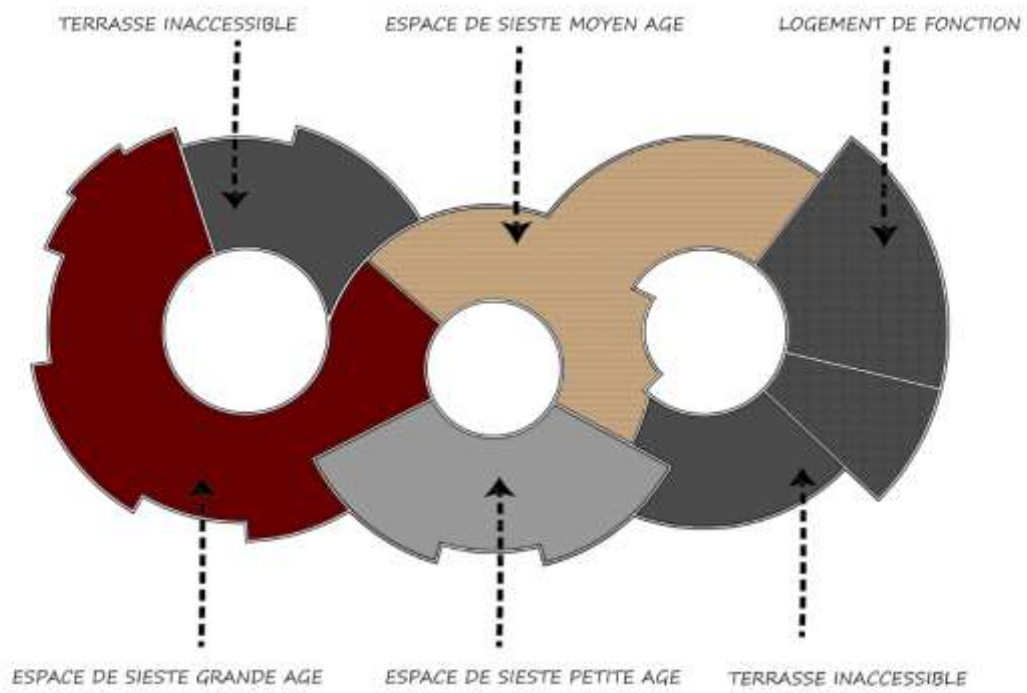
Schéma de plan de r+2 (Source : Auteurs)
